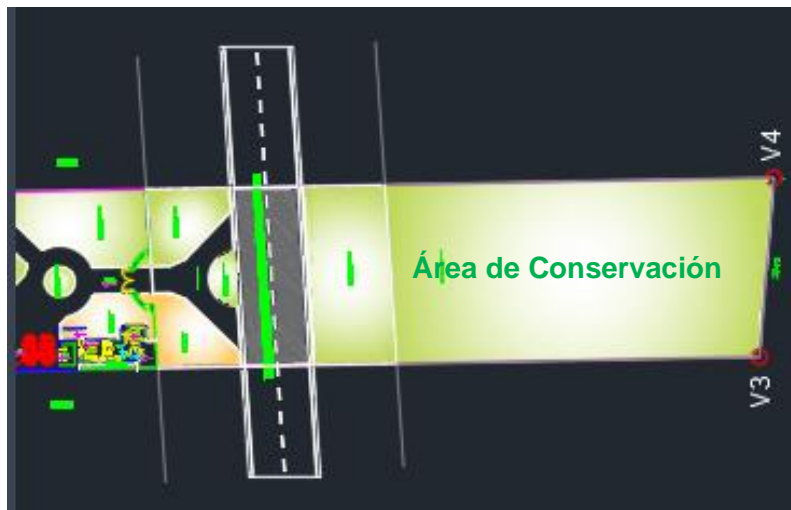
Plano Sur Áreas de Ocupación y conservación del proyecto.
